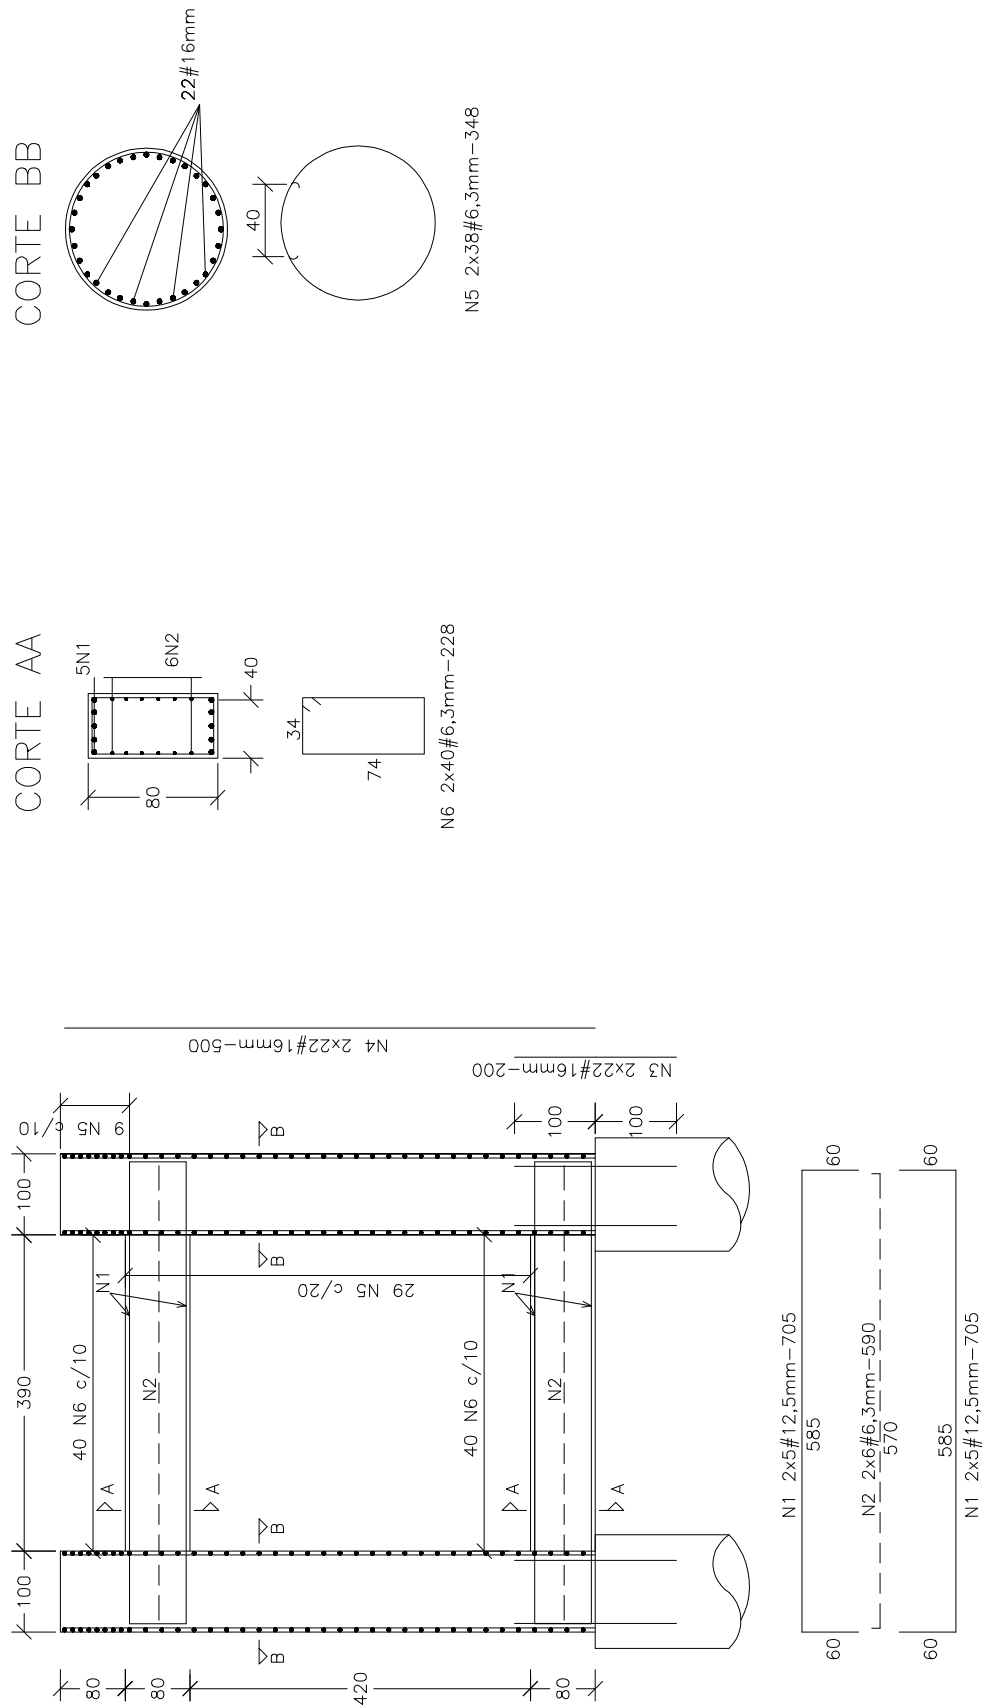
(b) - Detalhe da armadura dos eixos 2 e 3 da ponte sobre o rio Pau seco.
